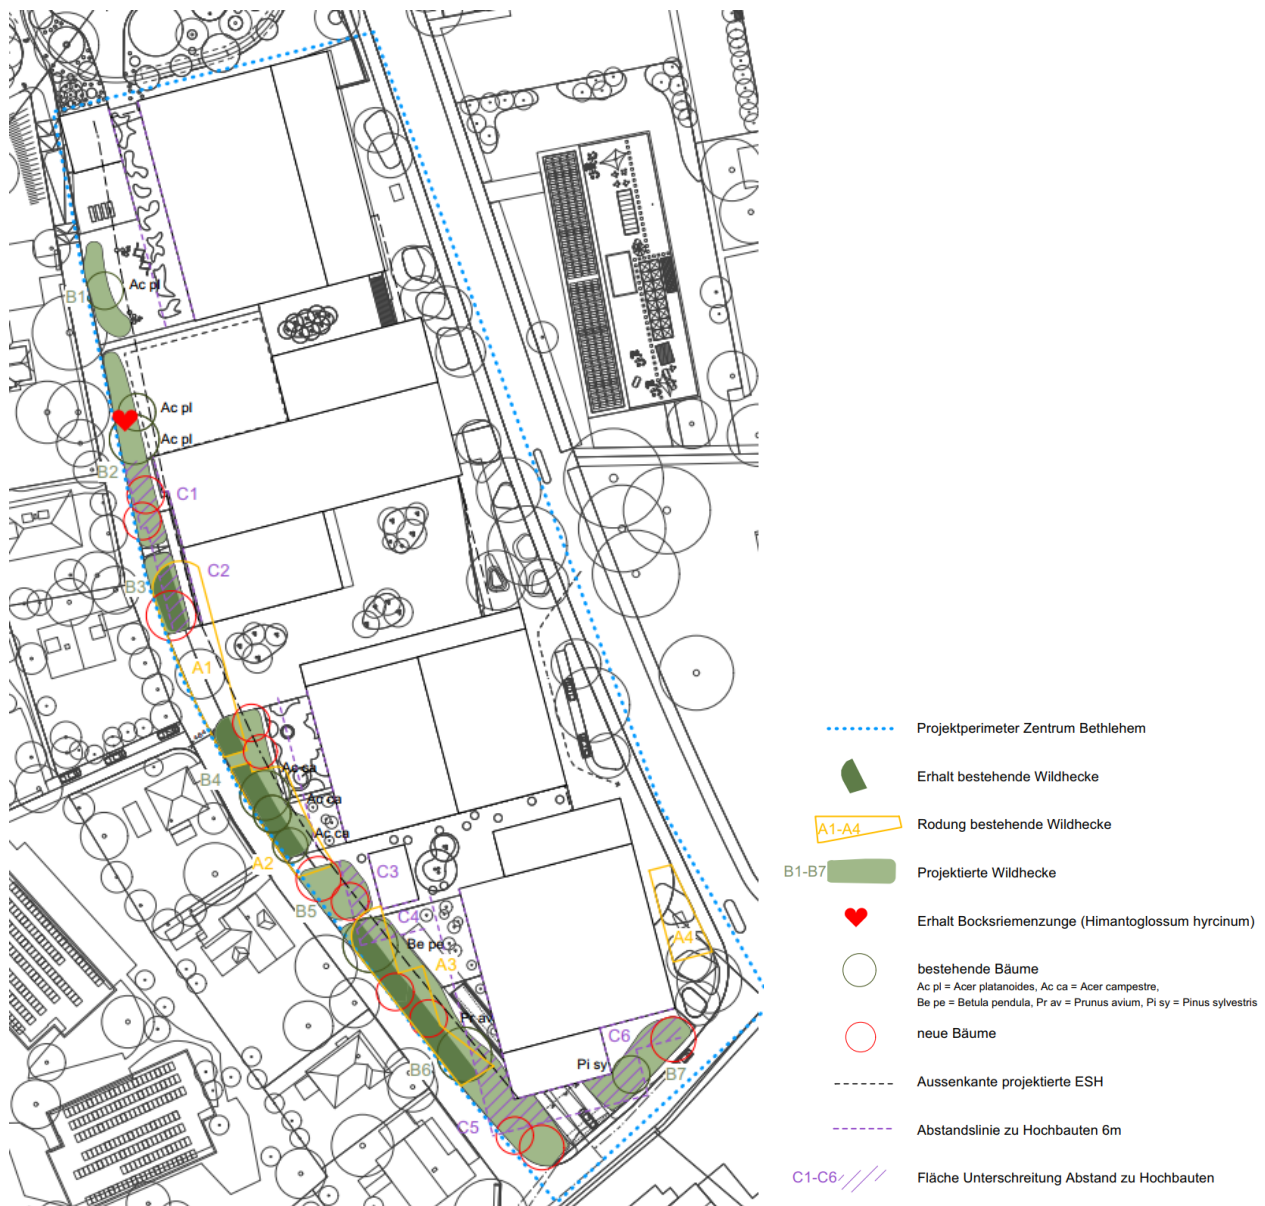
Areal West: Situationsplan, Konzept Wildheckenerhalt und -ersatz.
